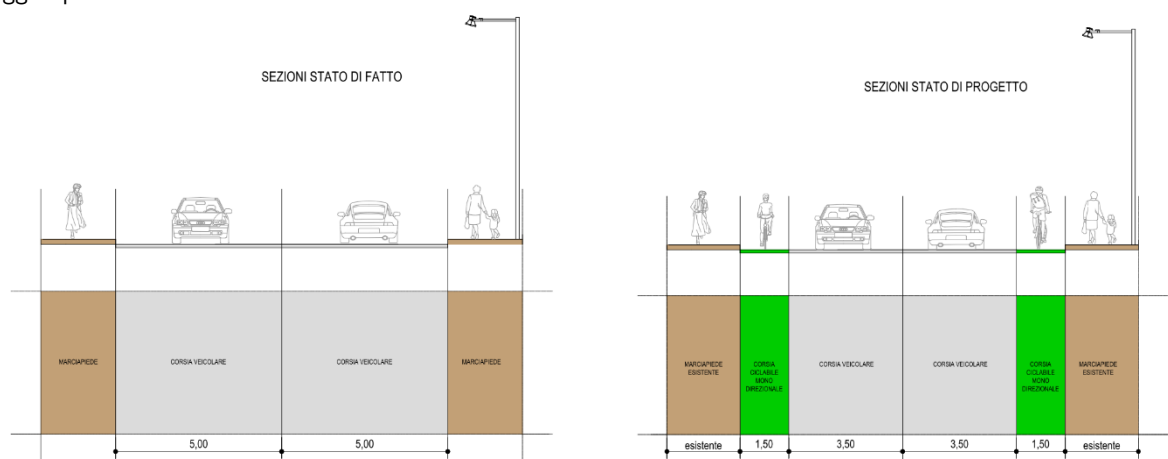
Sezione tipo e di progetto di via Sanvito Silvestro
